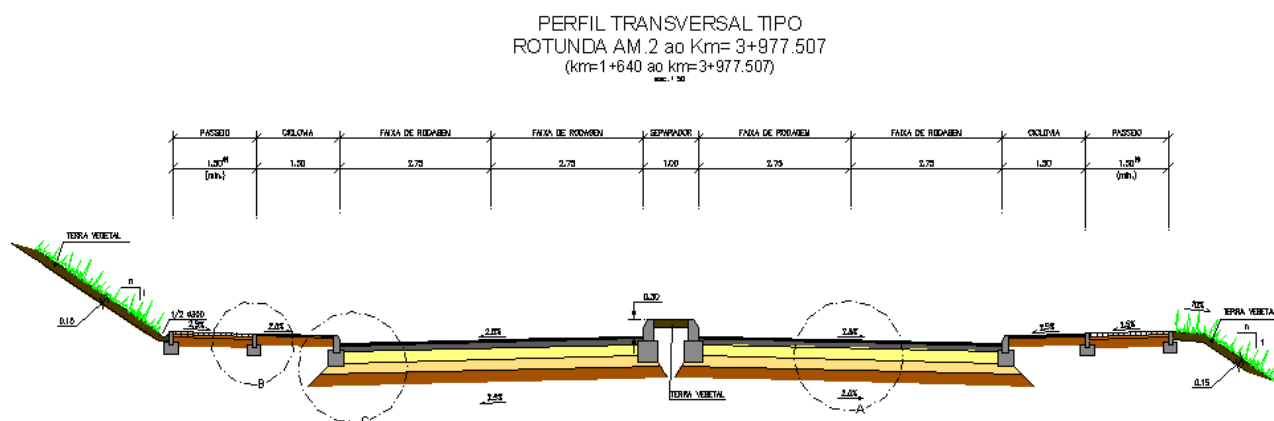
Perfil Transversal Tipo do troço entre a Rotunda A.M.2 e o final da intervenção
